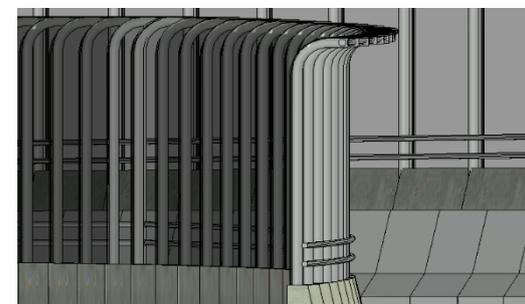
Tampilan Placing Permodelan Upper Structure Sesuai dengan Elevasi
